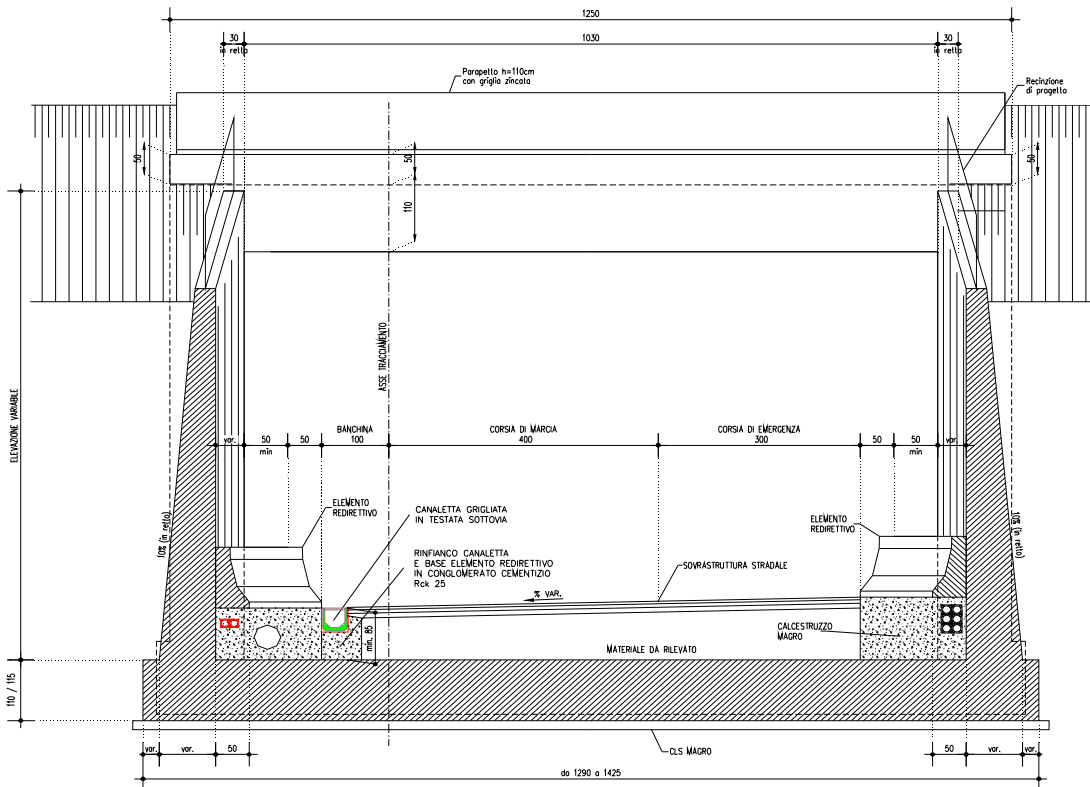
SEZIONE TRASVERSALE MURI
